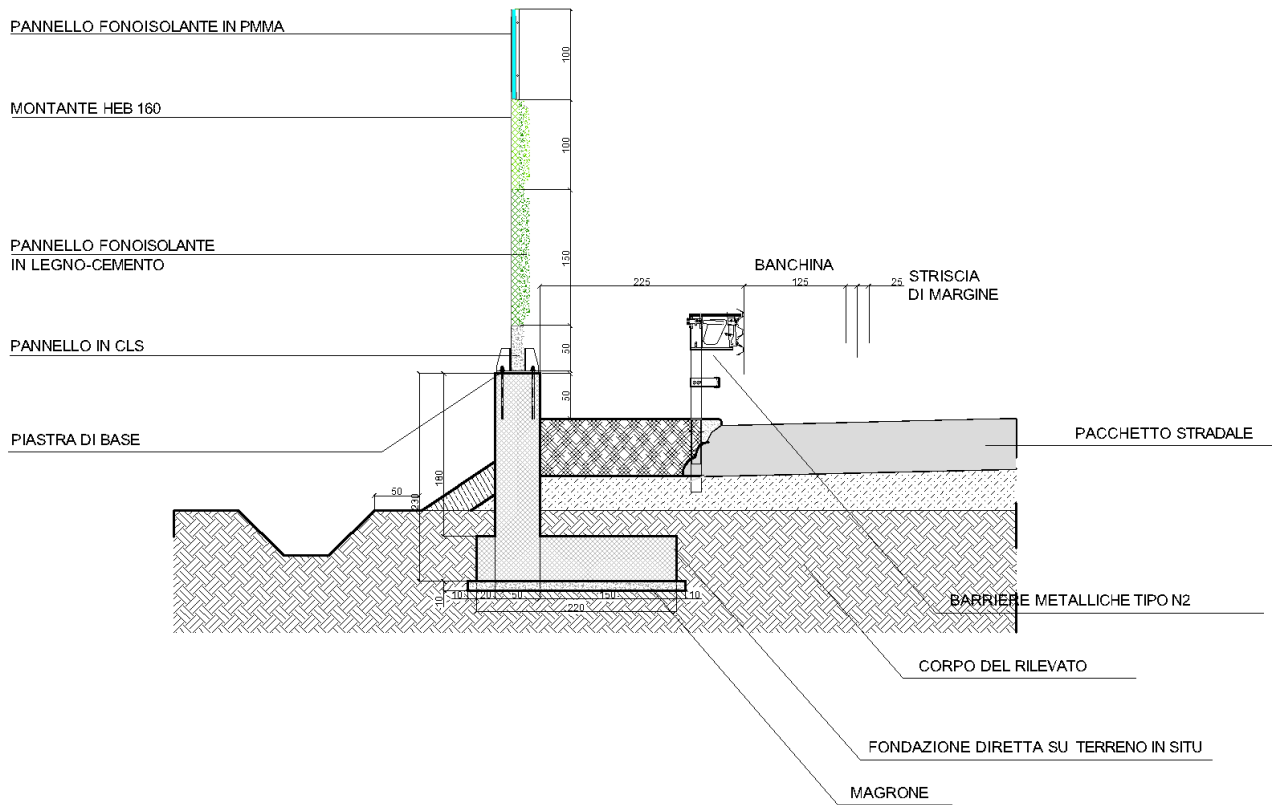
MURO BARRIERA CON FONDAZIONE SU TERRENO IN SITU
